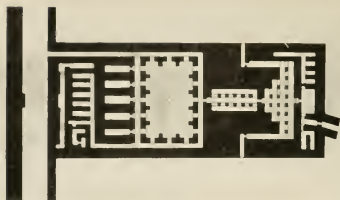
PLAN DE LA CHAPELLE DE CHÉPHRÈN.
